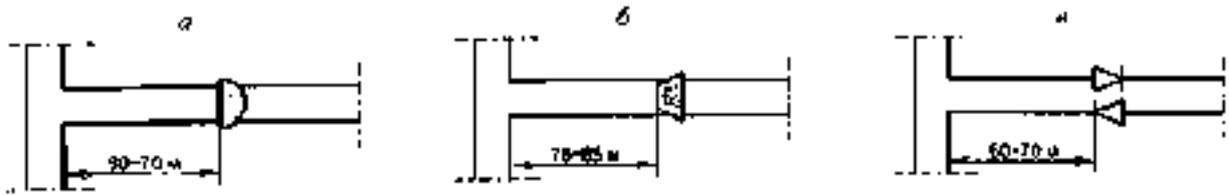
Схемы установки заслонов в конвейерной и вентиляционной выработках у сопряжений данных выработок с бремсбергами, уклонами, квершлагами
